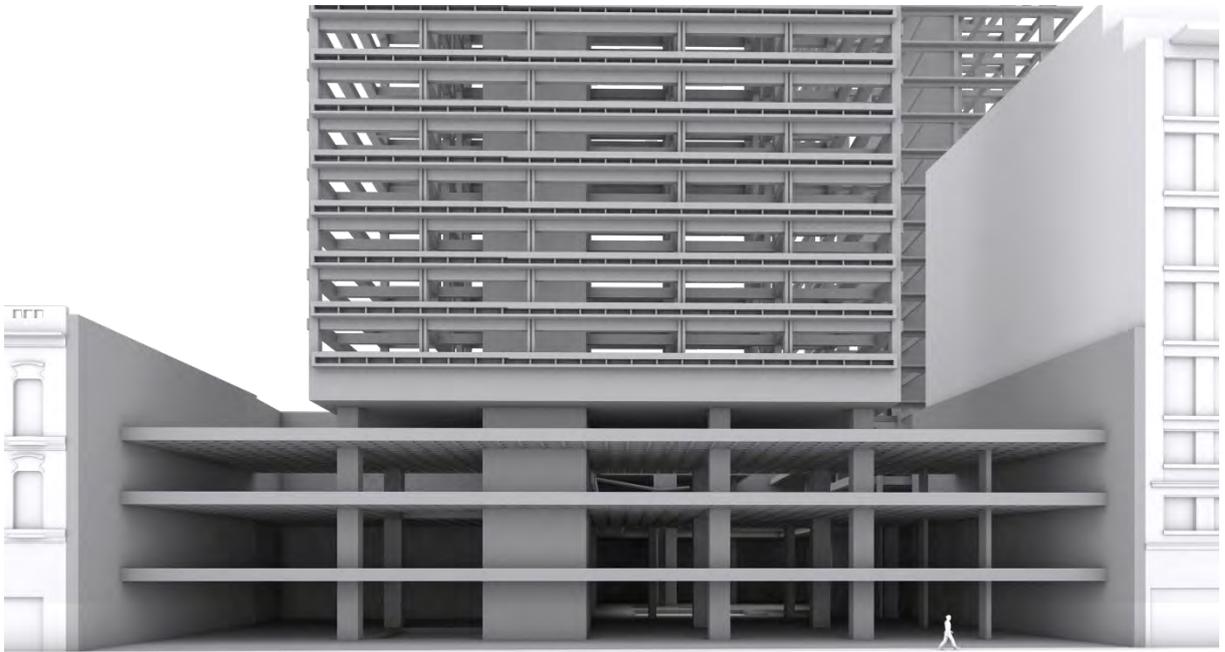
Detalhe da solução formal da estrutura de suporte no pavimento térreo junto a Rua Tucumán. Galeria Jardín, 1974-1984.
